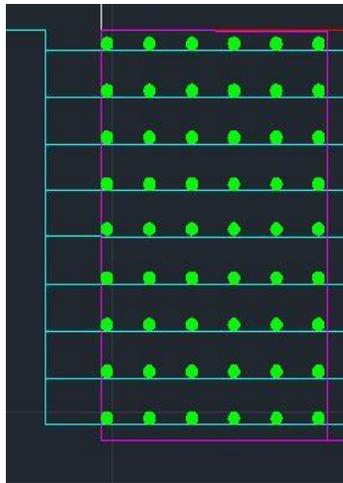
Colocación de plantas en uno de los 20 lotes o parcelas que se instalaran en la azotea.
